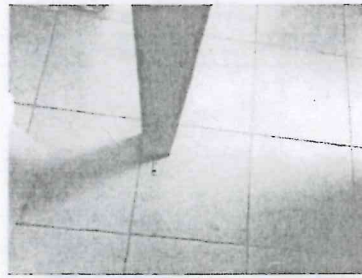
Columnas con deficiente arriostamiento área de archivo.
